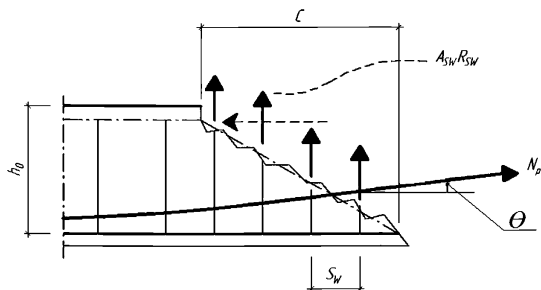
Расчетная схема усилий при расчете по наклонному сечению при действии поперечных сил
